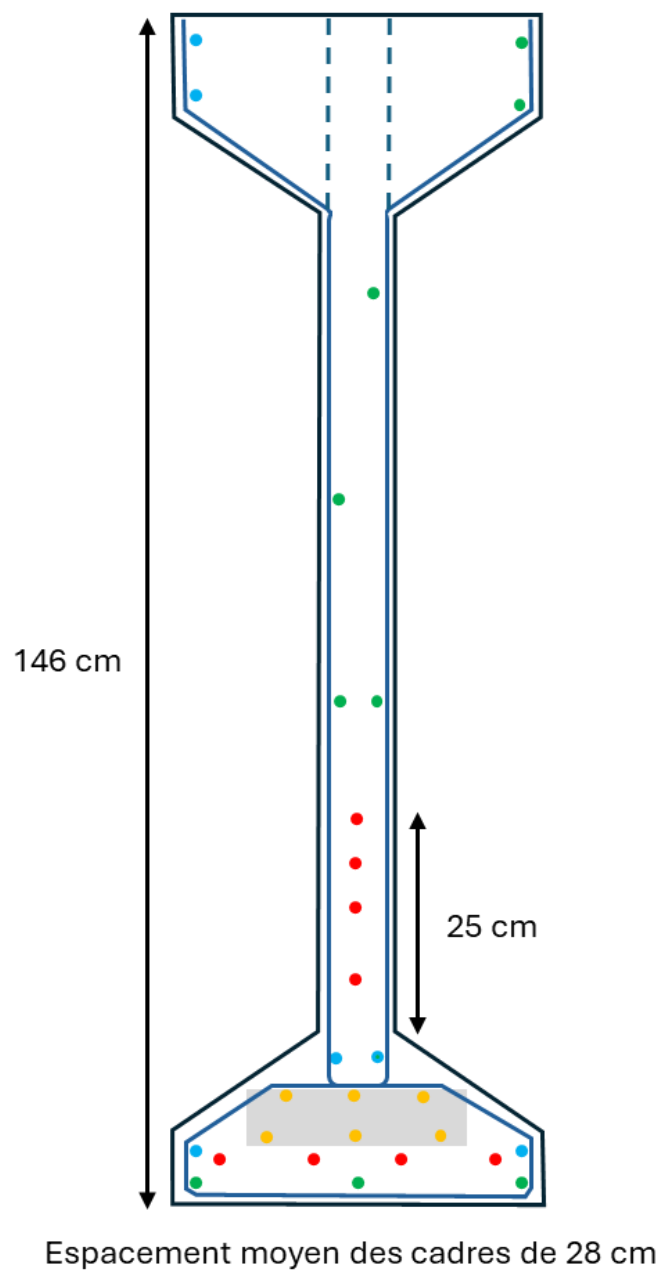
Coupe schématique du principe de ferrailage des poutres en partie courante
